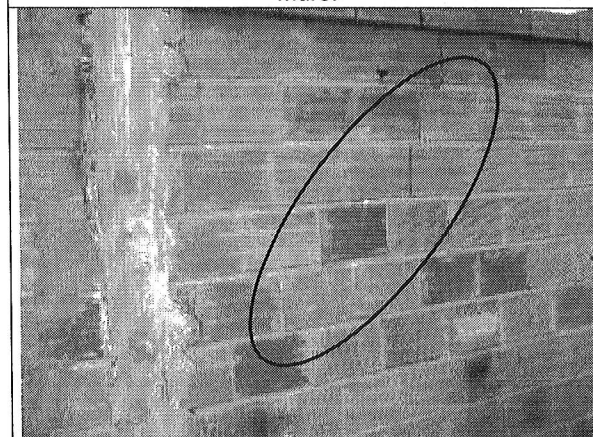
Agrietamiento diagonal en el muro del costado sur.
